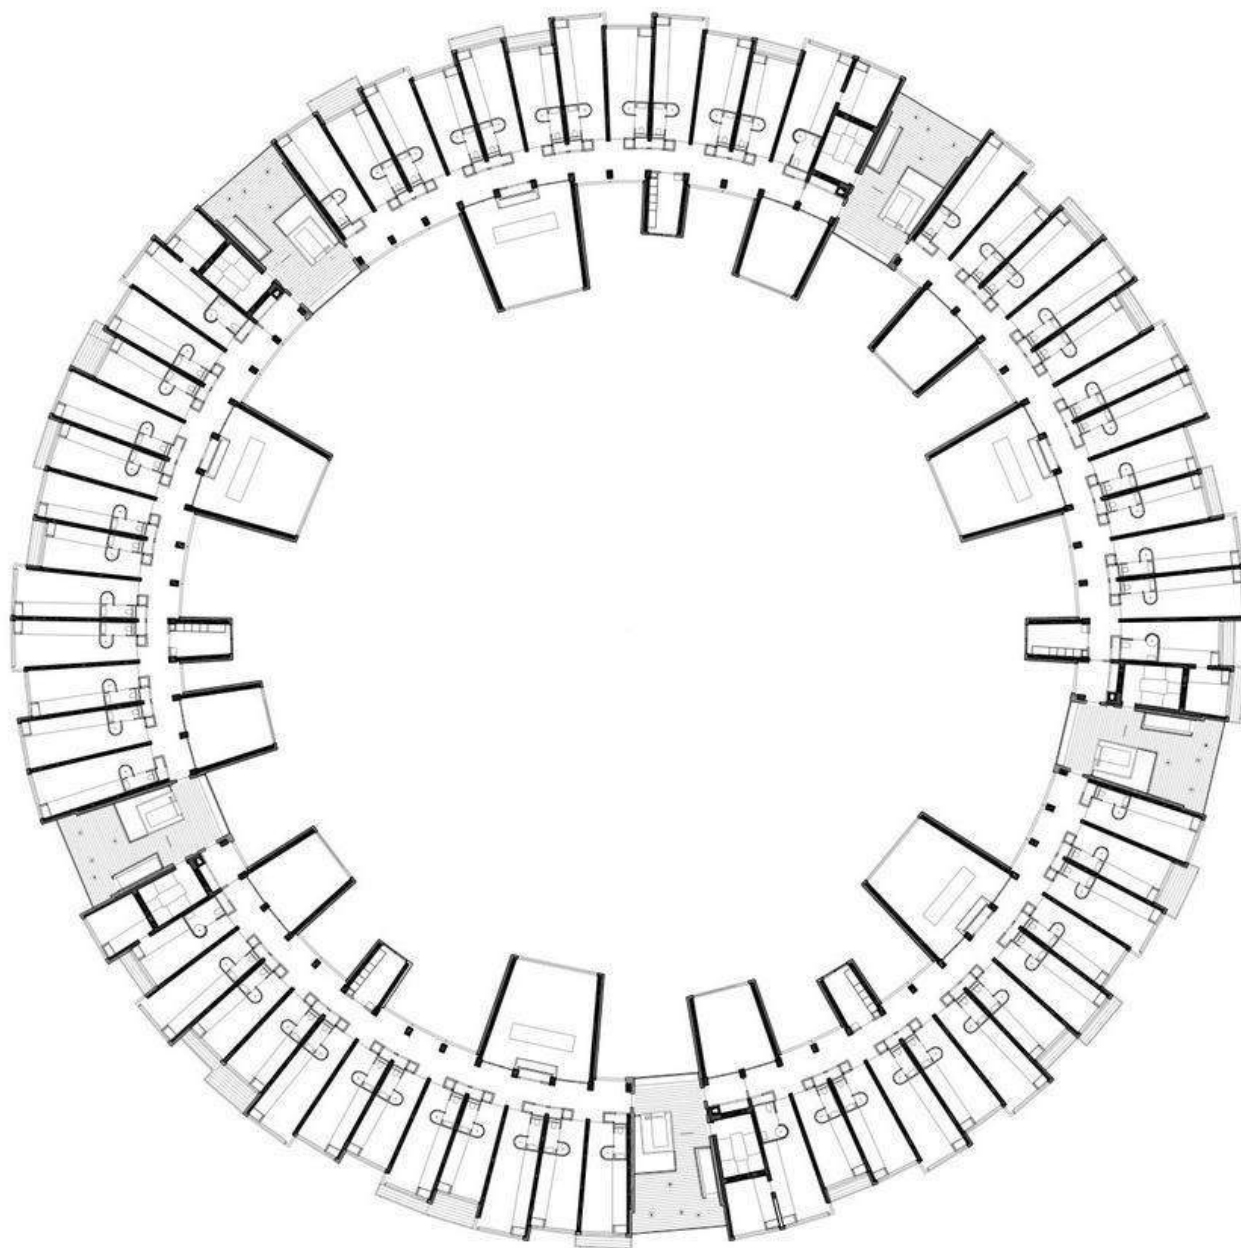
Wohngeschoß Grundriss Tietgen
